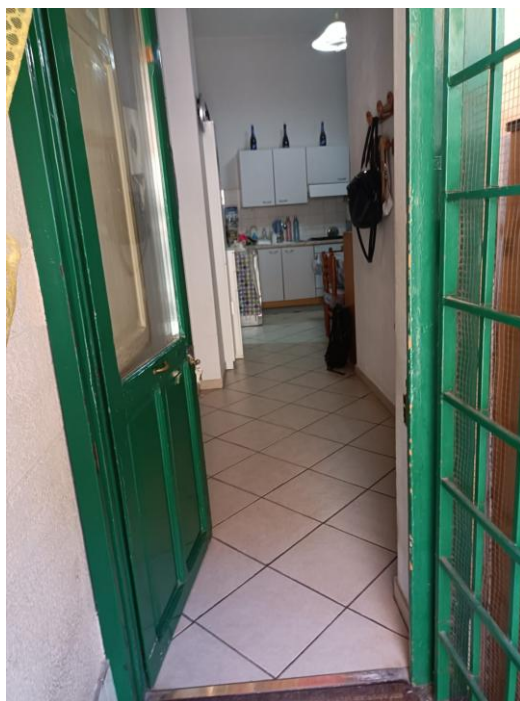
ingresso all'appartamento dal passaggio del civico 175
